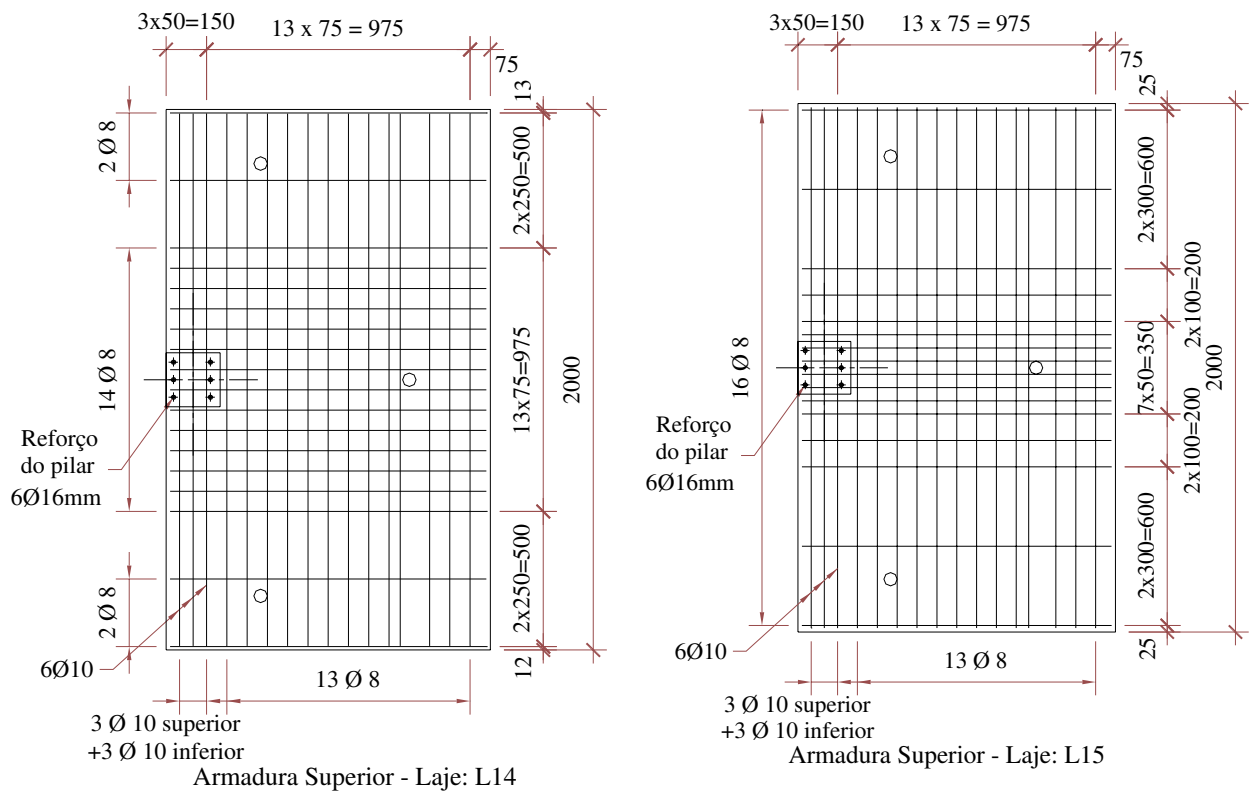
Disposição da armadura passiva superior das lajes L14 e L15 em planta (mm)
